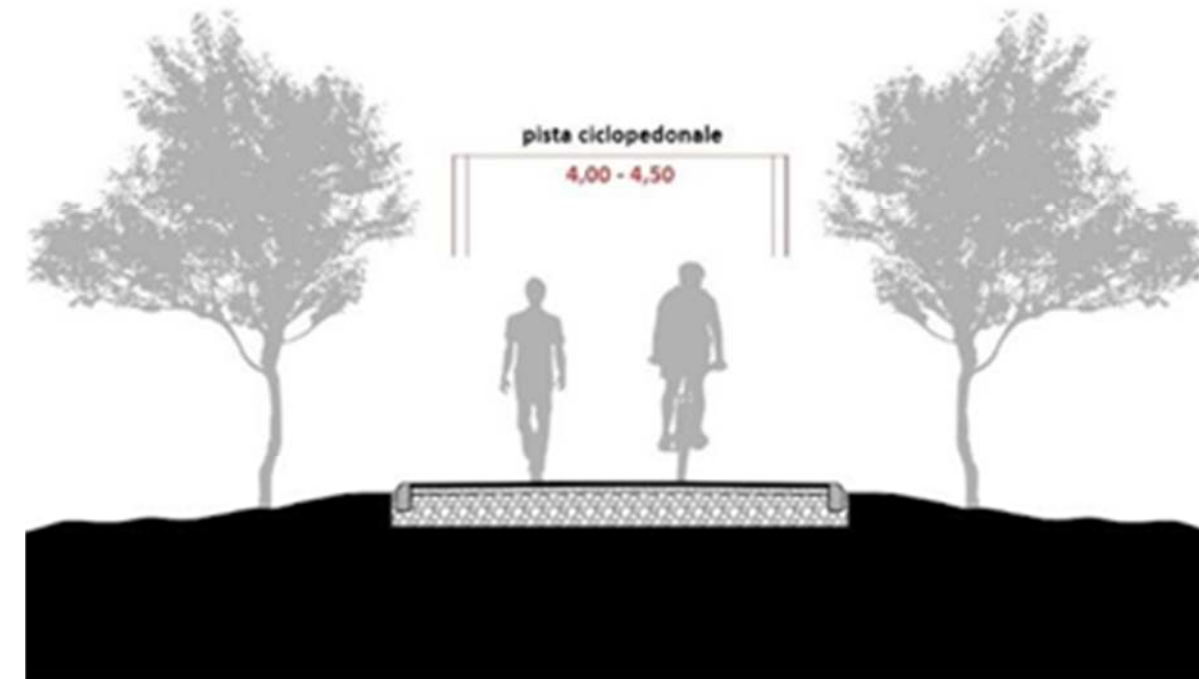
DETTAGLIO COSTRUTTIVO PISTA IN SEDE PROPRIA BIDIREZIONALE NON AFFIANCATA CICLOPEDONALE CON PAVIMENTAZIONE IN STABILIZZATO MISTO CAVA
